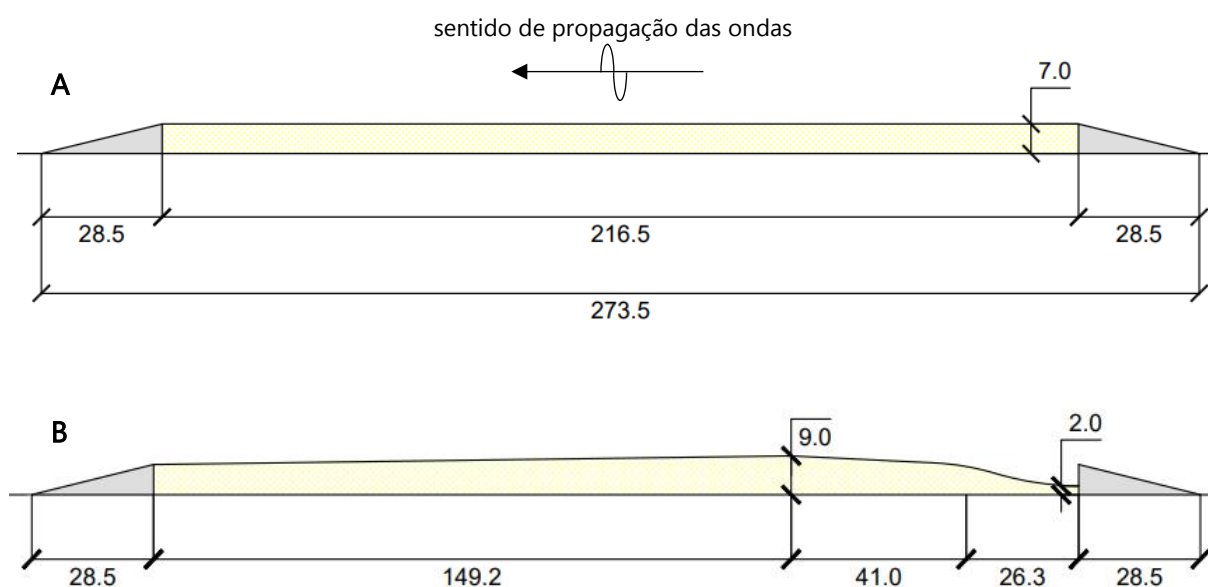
Geometrias dos perfis de ensaio plano horizontal.
